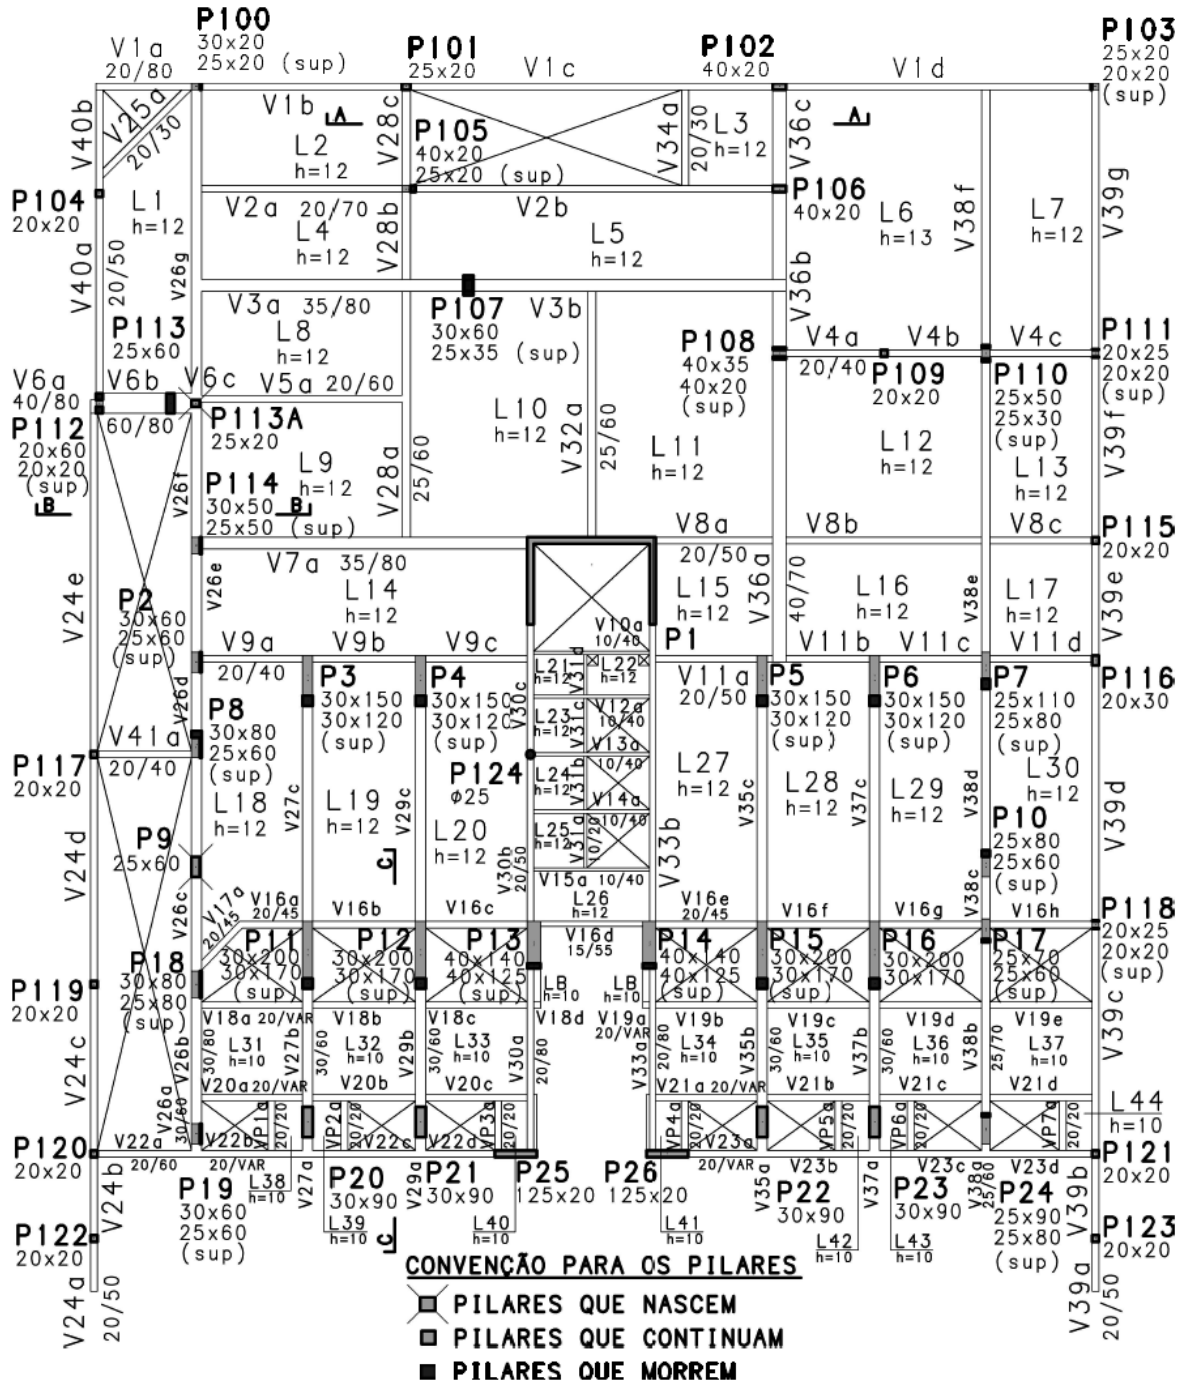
Planta da primeira laje, garagem, el.+3,05.
